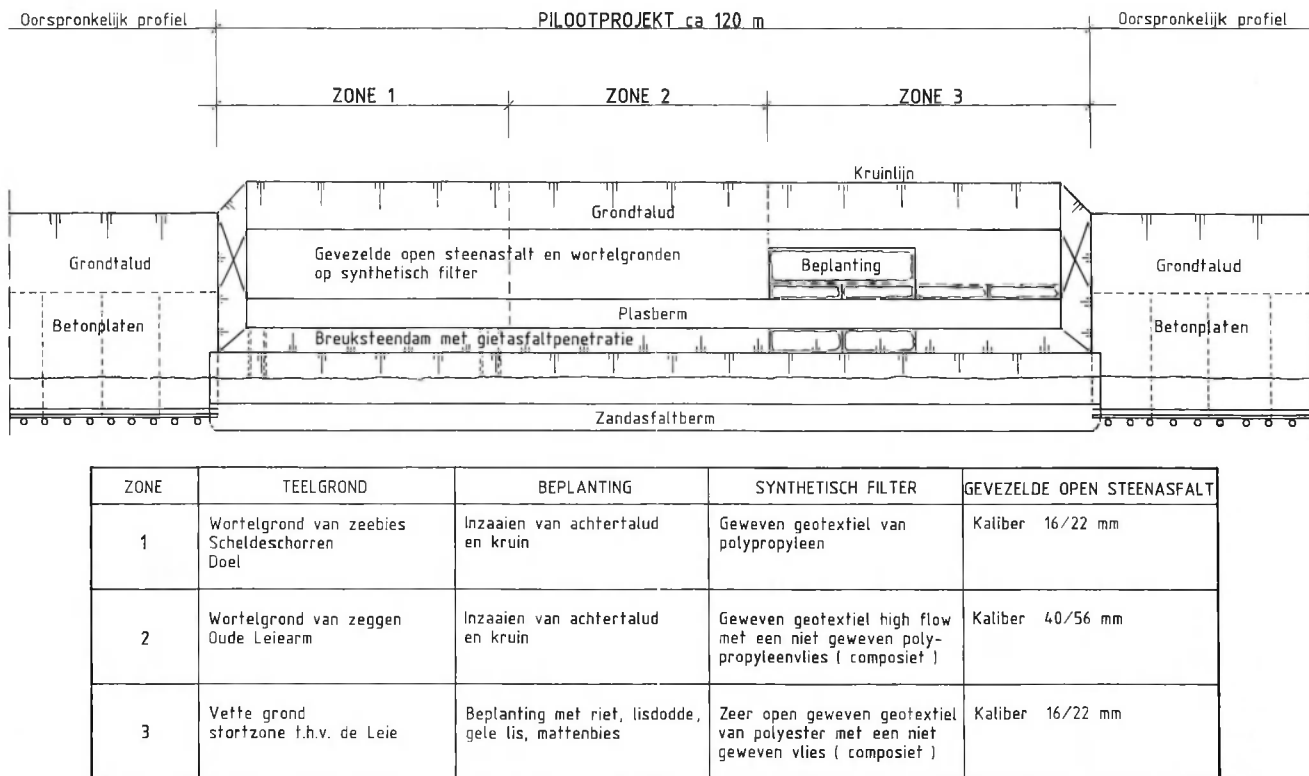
Schema van de verdeling van het pilootproject in verschillende zones voor het vergelijken van diverse bouwmaterialen, gronden en beplantingen.
